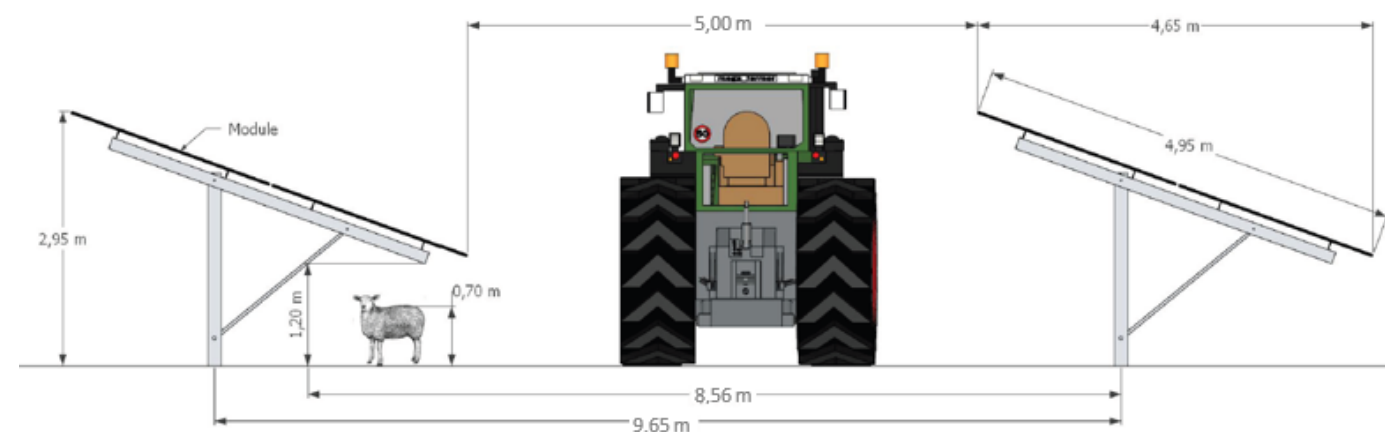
Vue en coupe des structures projetées (source : SAMSOLAR)
